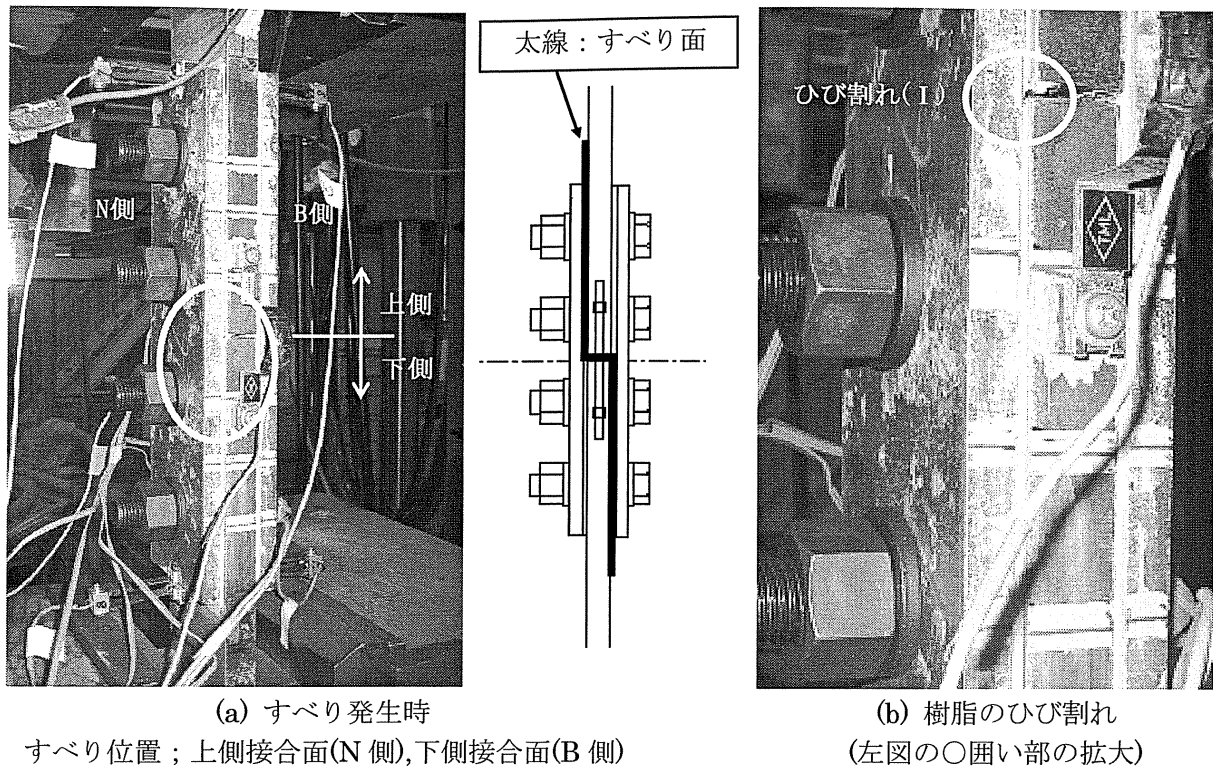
すべりと同時に発生した樹脂のひび割れ(I)
